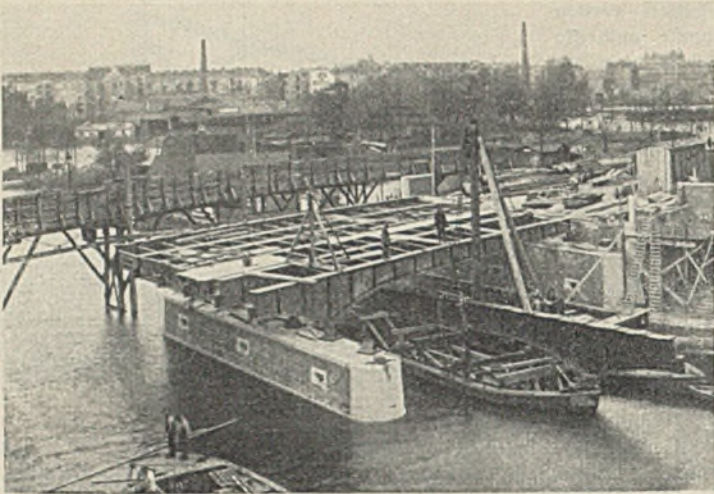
Billekanal-Brücke im Zuge des Billhornerdeichs; Montage.
